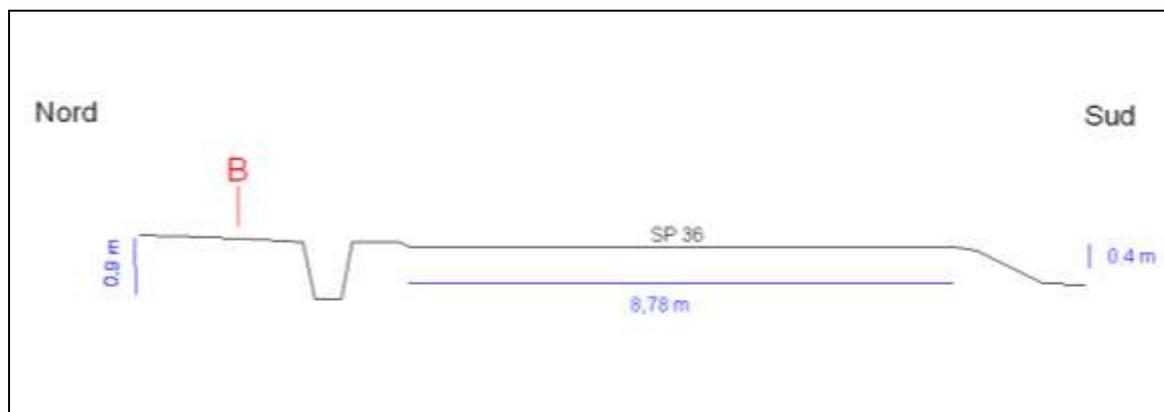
Sezione schematica del tratto stradale di interesse (SP 36)
